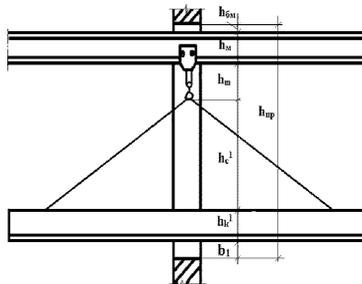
Перемещение строительных конструкций при использовании подвесных грузоподъемных средств
